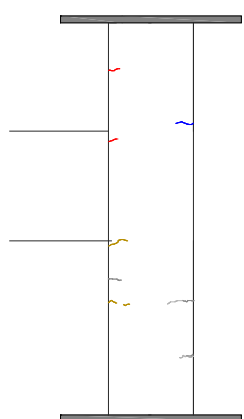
(b) ひび割れ状況（試験体 F2）
